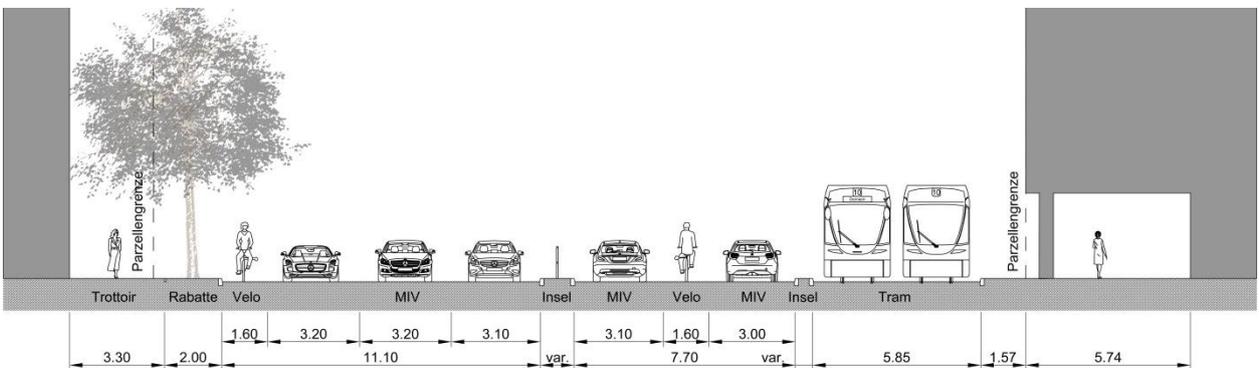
Querprofil B-B im Abschnitt Brüglingerstrasse bis Walkeweg (Projekt)
